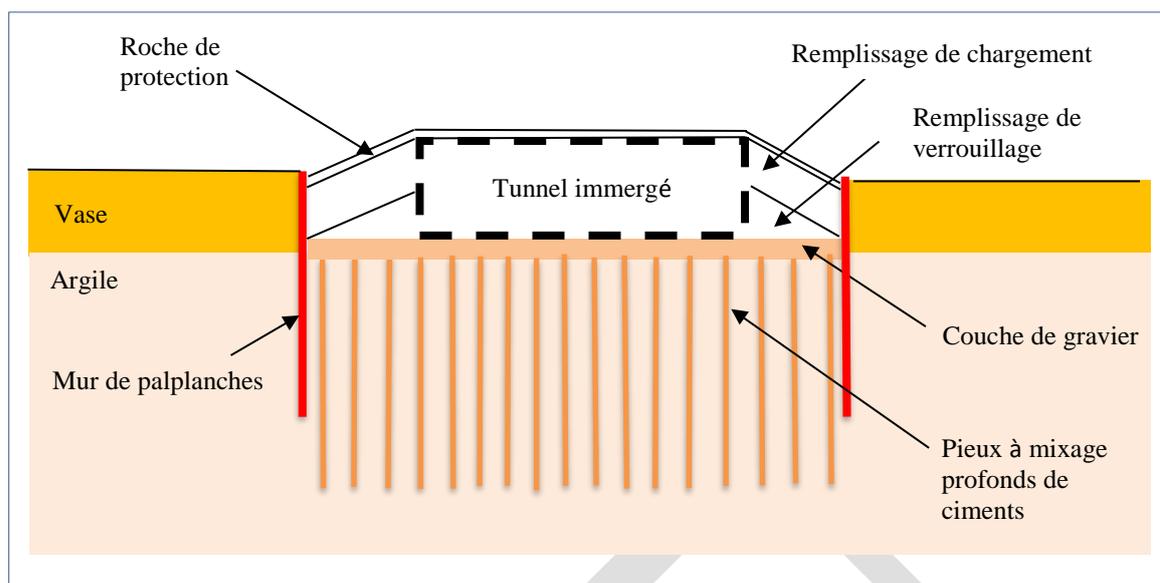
Travaux de terrassement pour la variante A utilisant les pieux à mixage profonds de ciments MPC
